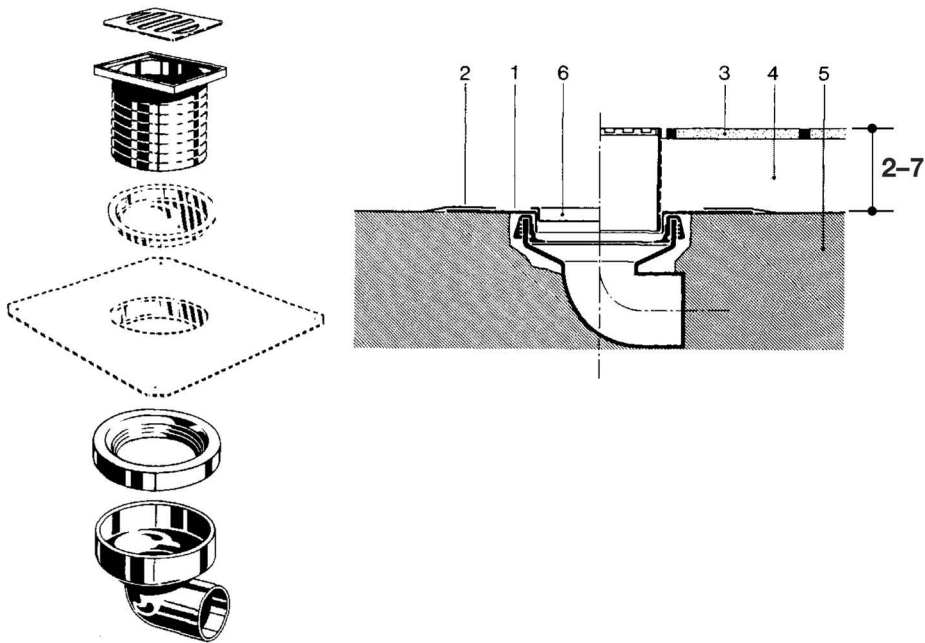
Einbau mit Anschlussblech, in Boden mit Plattenbelag
